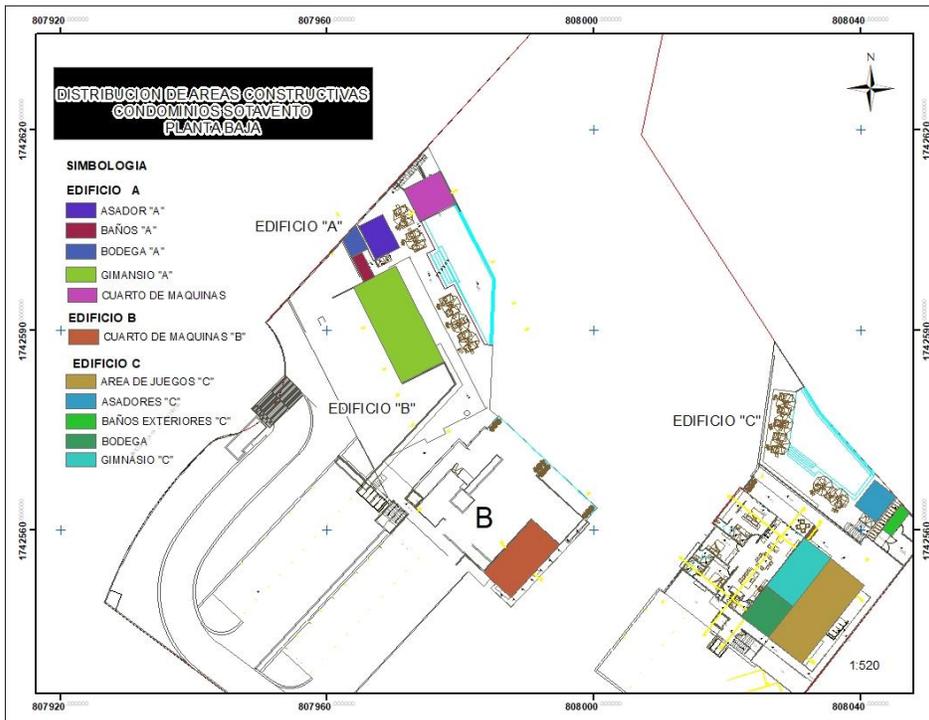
Distribución de las superficies constructivas en Planta Baja
